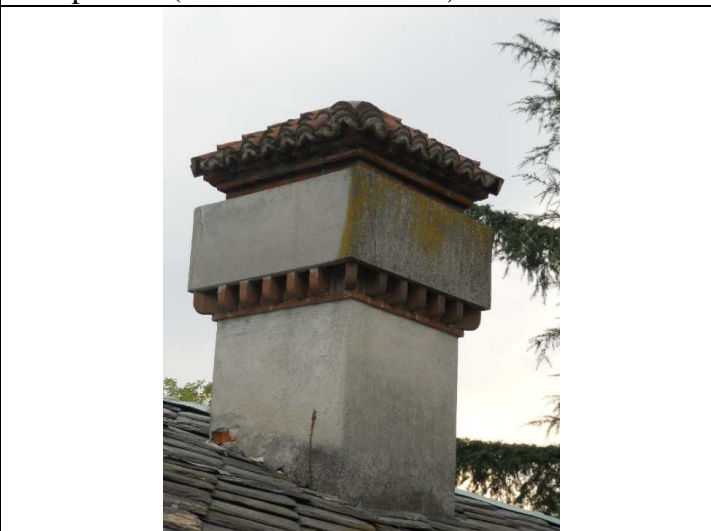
Dettaglio dell'intonaco dei camini ammalorato
